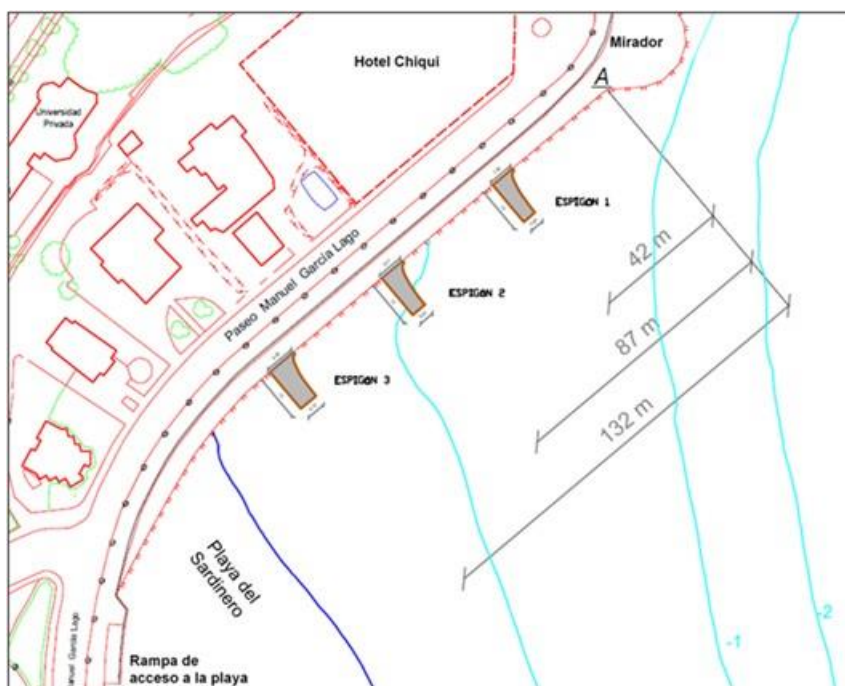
Plano de situación de los tres espigones. Fuente: planos del Proyecto
